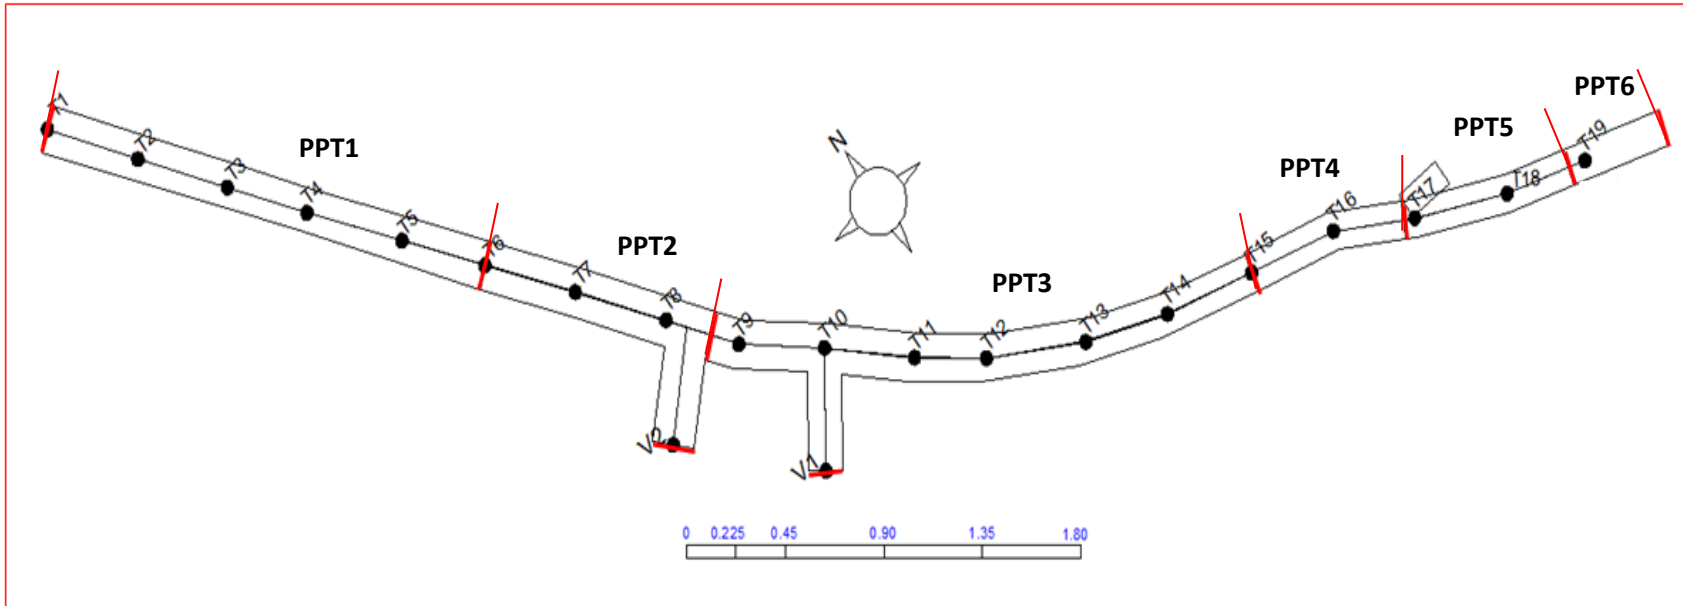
Vista en planta de la distribución de pozos del ramal Tláhuac e intervalos donde aplica el diseño de los futuros pozos de reposición.
